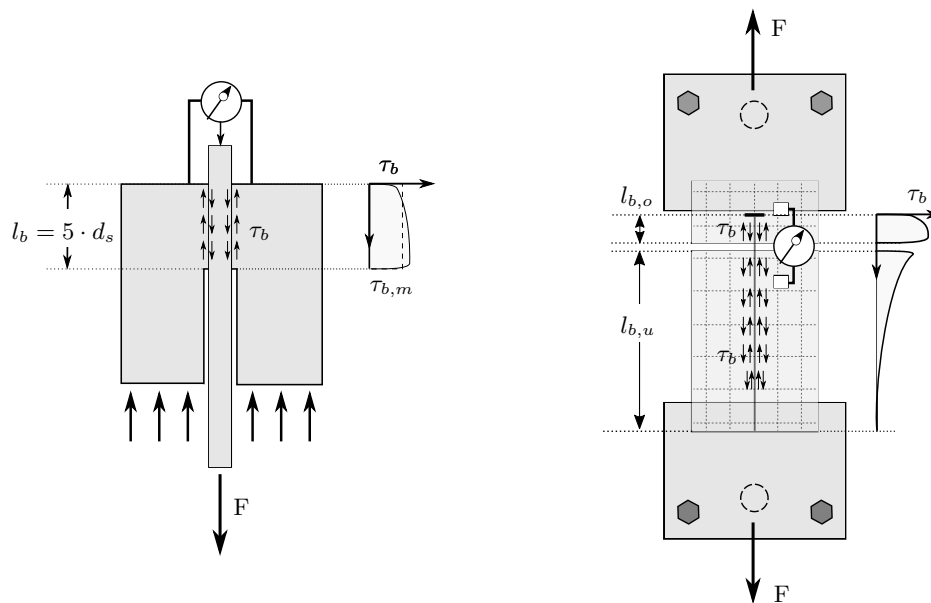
Verbundmodelle für Stahlbeton/Textilbeton
